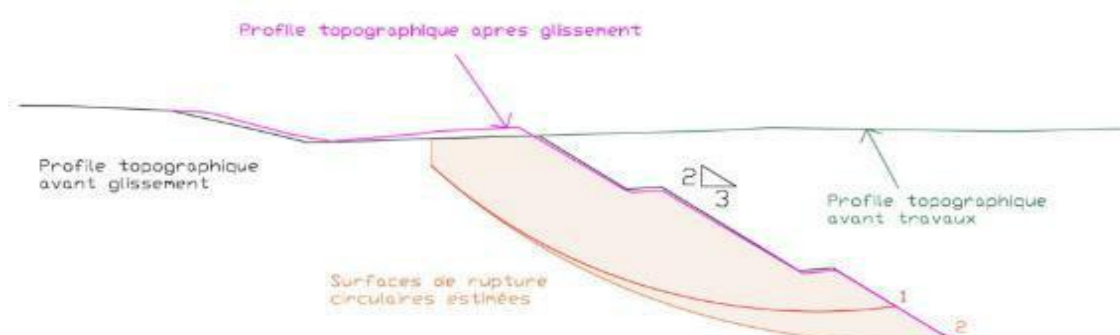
Reconstruction de la surface de rupture (coupe à la PK44+580).
